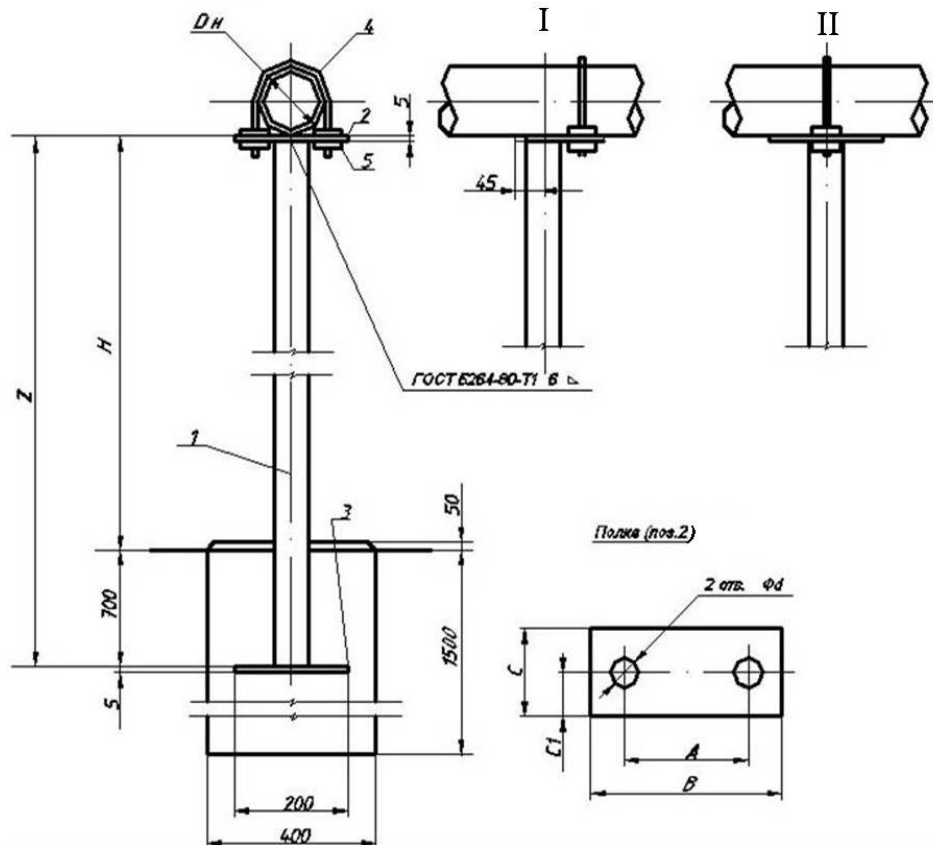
Крепление газопровода на опоре: I – газопровод Ду32; II – газопровод Ду65
